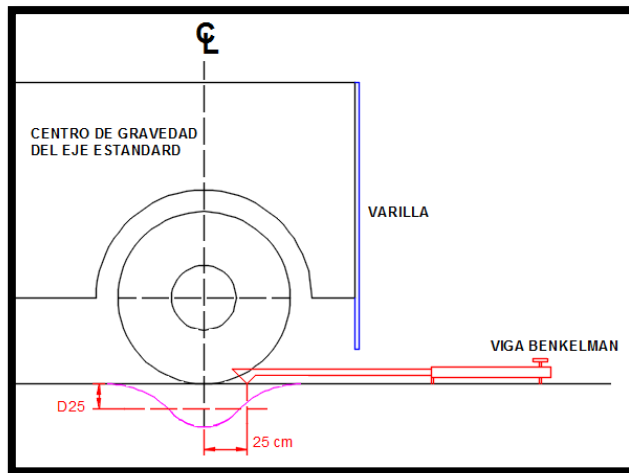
Alineamiento del extremo de la Viga Benkelman con el centro de las llantas.
